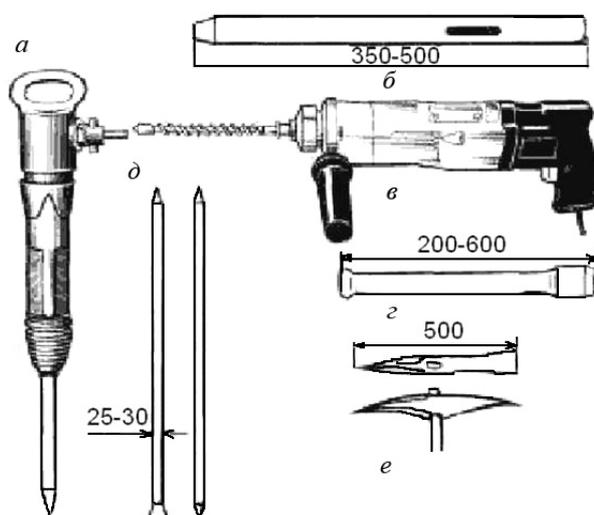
Инструменты для разборки и ремонта кладки:
